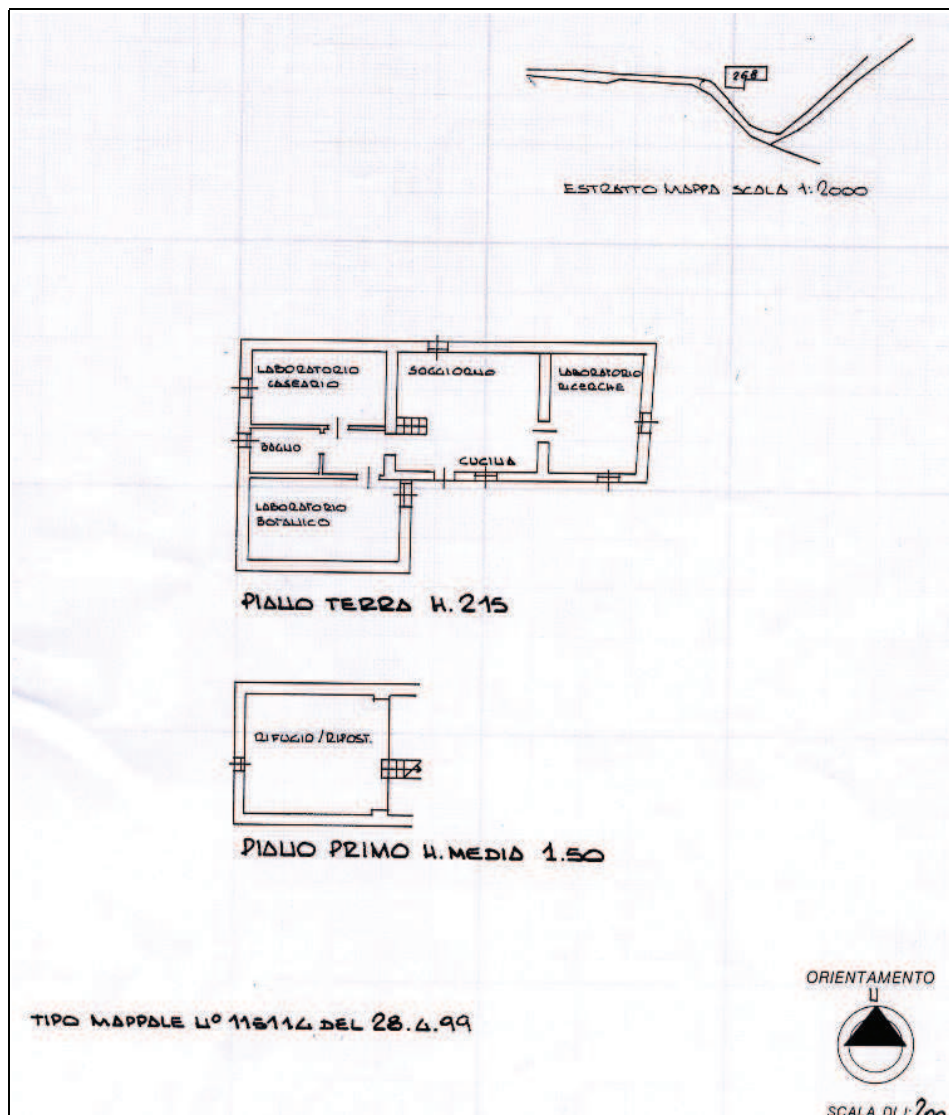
Planimetria 1:200 della Baita Neel Bassa elaborata dall'Ufficio Urbanistica della Provincia di Bergamo
